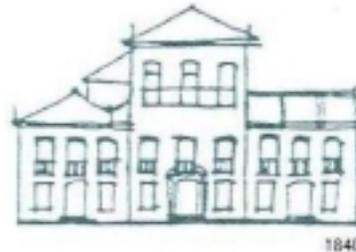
Fachada voltada para Praça XV, Paço.
